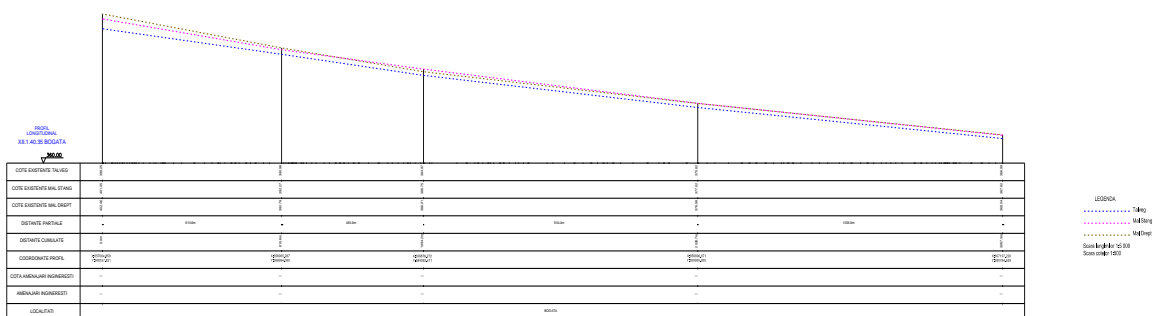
Exemplet profil longitudinal – Raul Bogata
